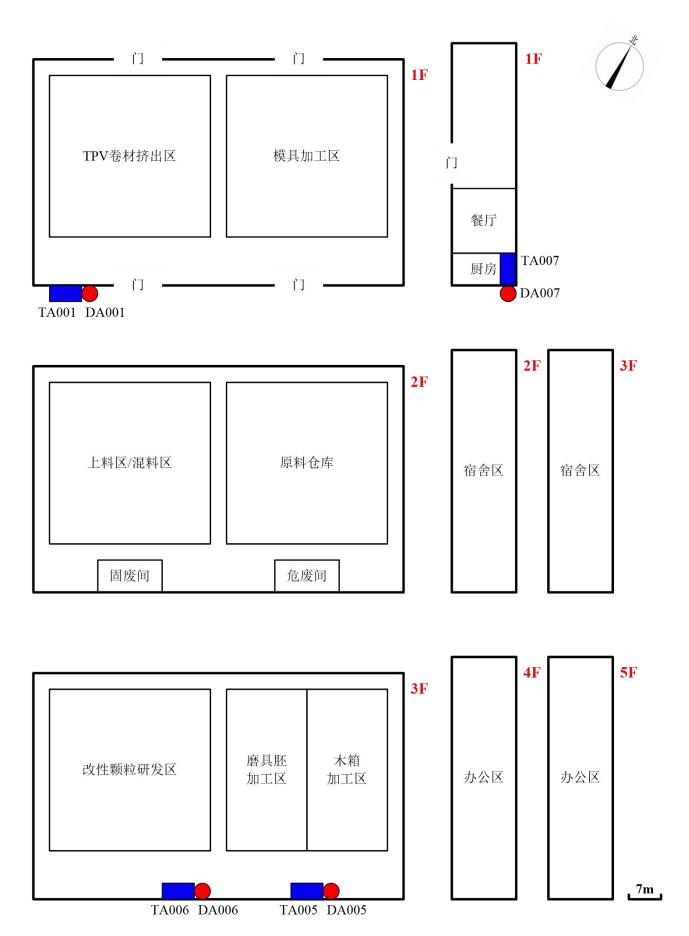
项目车间平面布置图(2#厂房、综合楼)
